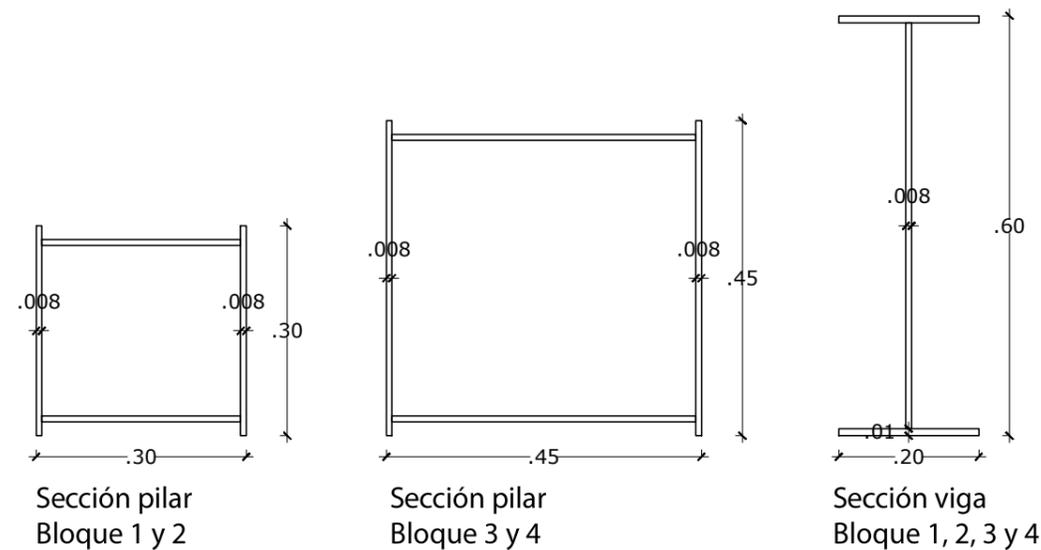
Sección de columnas y viga bloques 1, 2, 3 y 4
